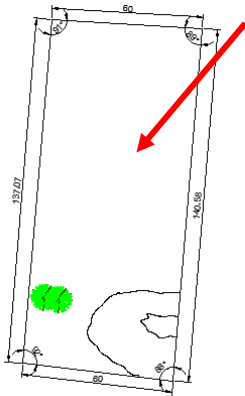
Vista del predio, se contempla el terreno a construir. Elaboración propia.
